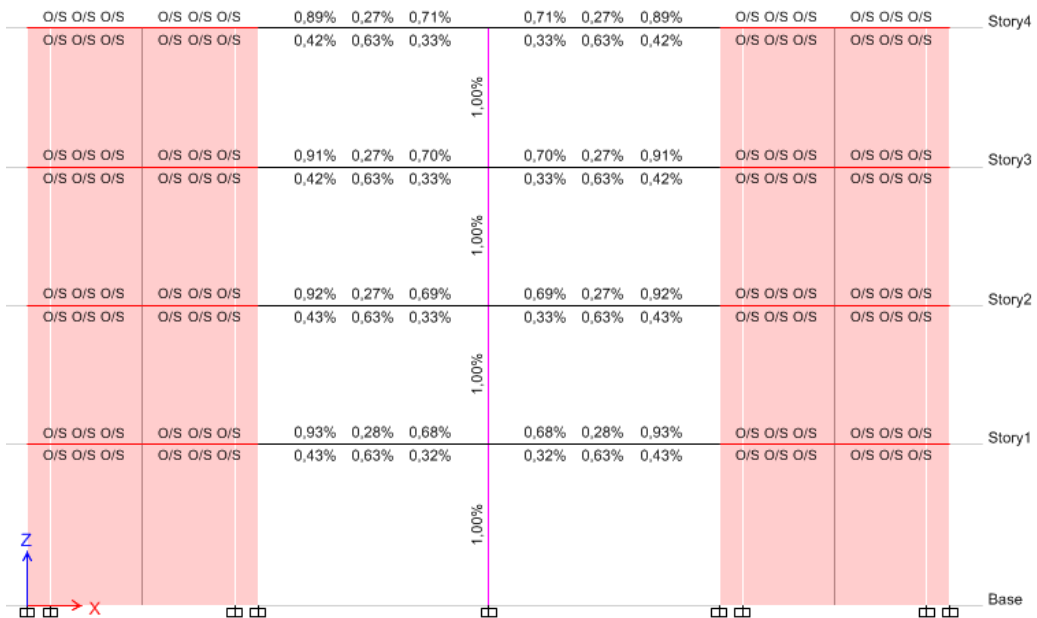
Cuantía de refuerzo para pórtico de edificio con muros 4 pisos, DBF.
